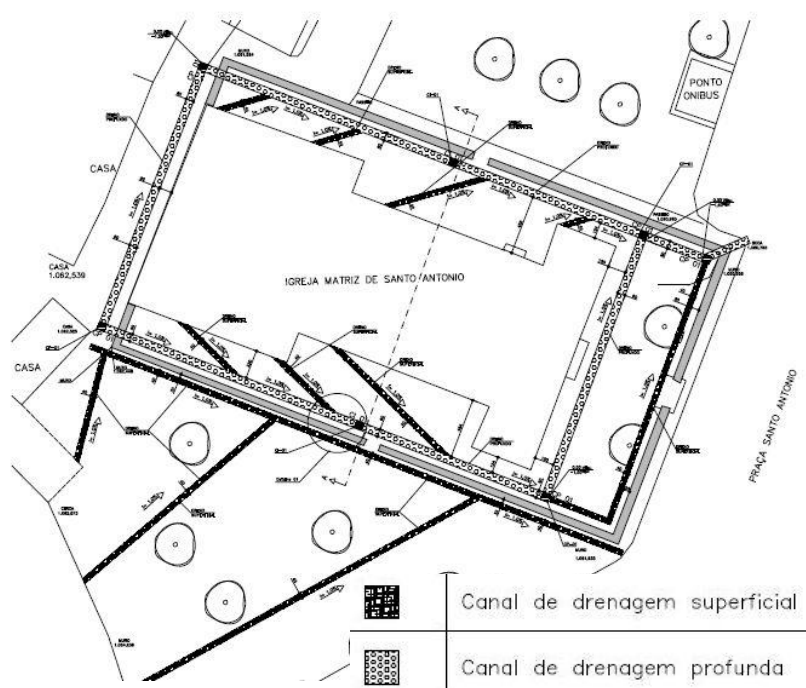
Planta de drenagem da restauração da edificação. Fonte: Acantos.
